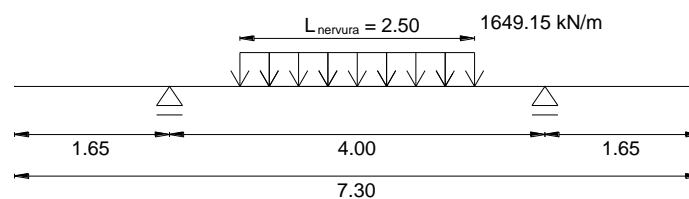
MODELO DE CÁLCULO ADOPTADO PARA A ANÁLISE DAS CARLINGAS DE APOIO
